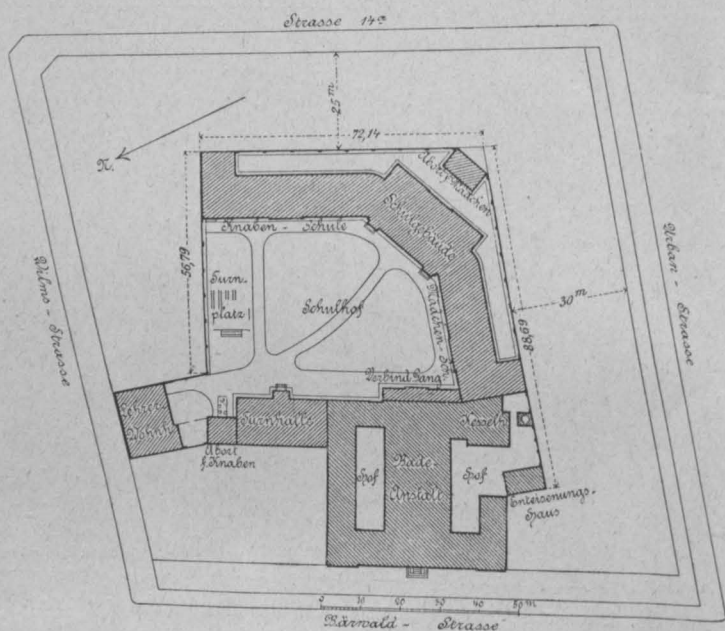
Lageplan der Schule, Wilmsstraße, und der Badeanstalt, Bärwaldstraße.
